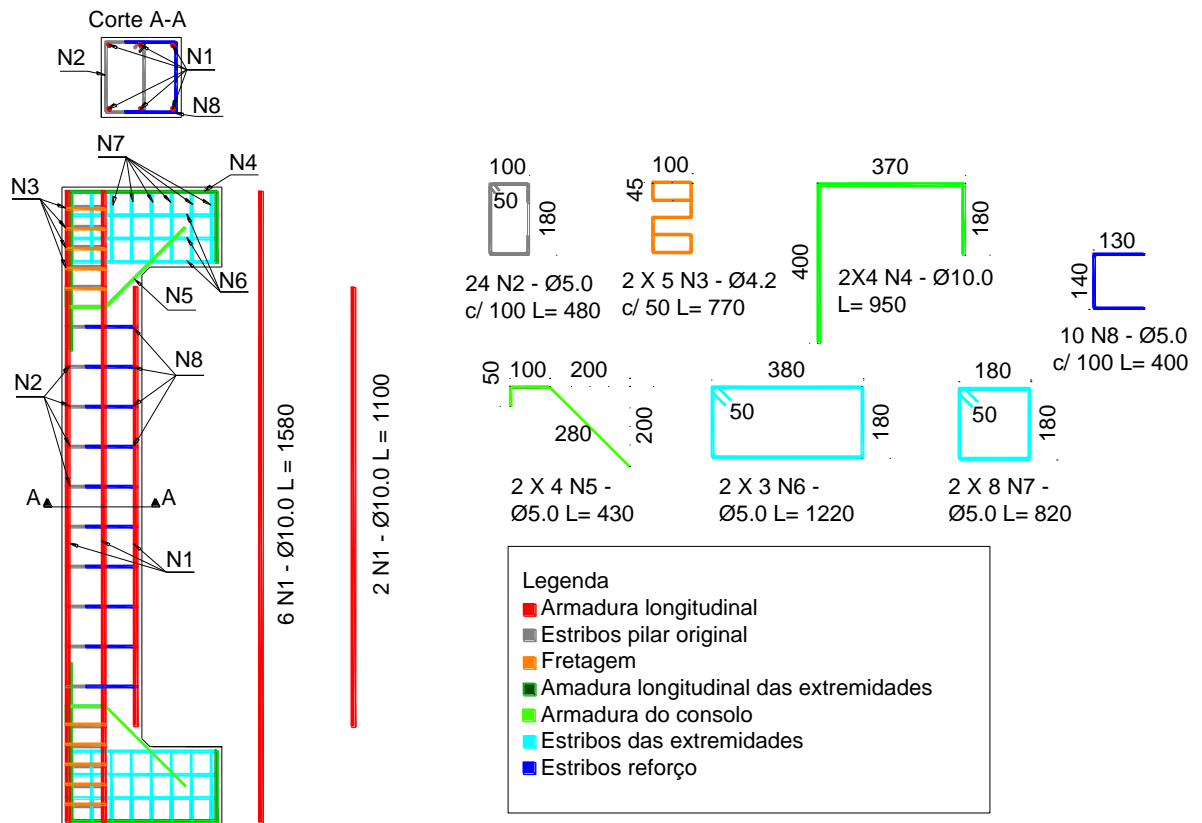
Detalhamento da armadura dos pilares de referência e reforçados a compressão
